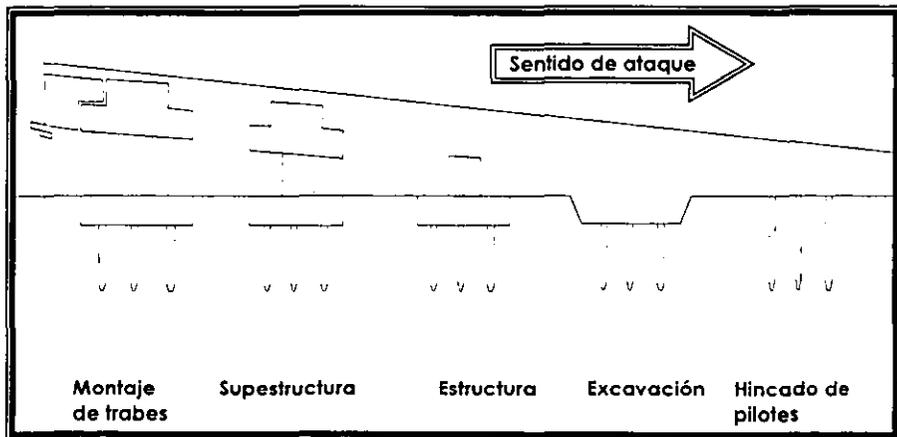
Sentido de ataque al proyecto del Distribuidor Vial.
